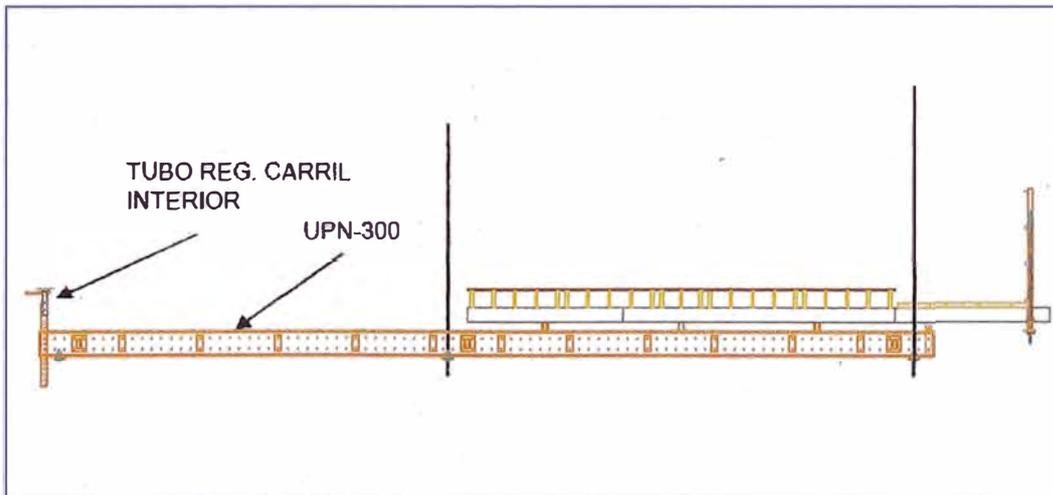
Viga carril de encofrado interior - Fuente: Elaboración Propia
